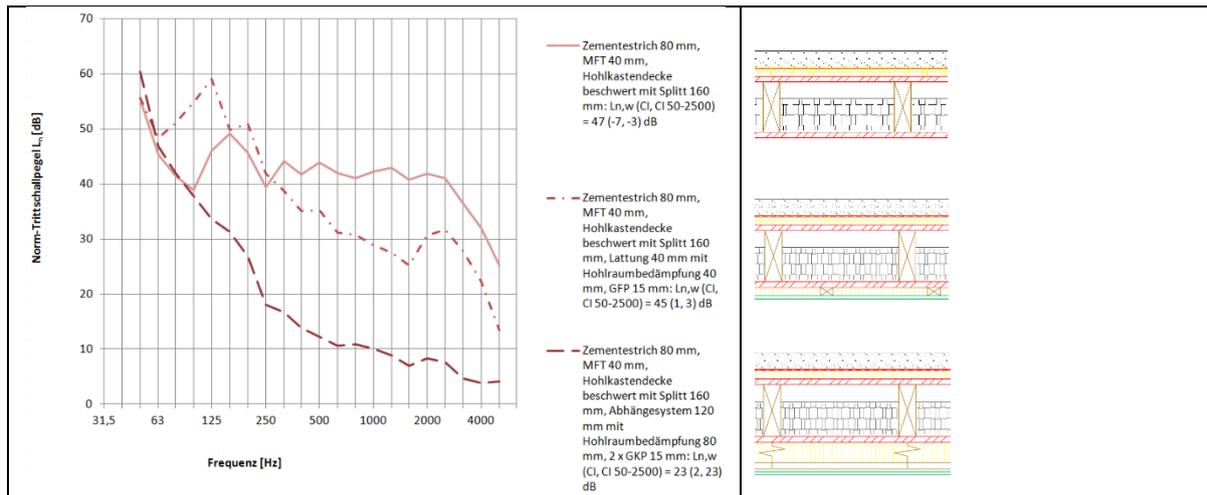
[4]: Vergleich von unterschiedlichen Unterdecken bei einer mit 160 mm Splitt gefüllten Hohlkastendecke und zusätzlichem Bodenaufbau mit Glasfaser-Trittschalldämmung 2 x 20 mm ( $s' = 9 + 9 \text{ MN/m}^3$ ) und Zementestrich 80 mm (Norm-Trittschallpegel  $L_n$ )
